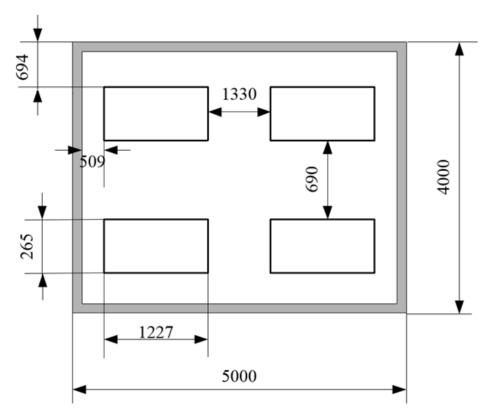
План помещения и размещения светильниковс люминесцентными лампами
